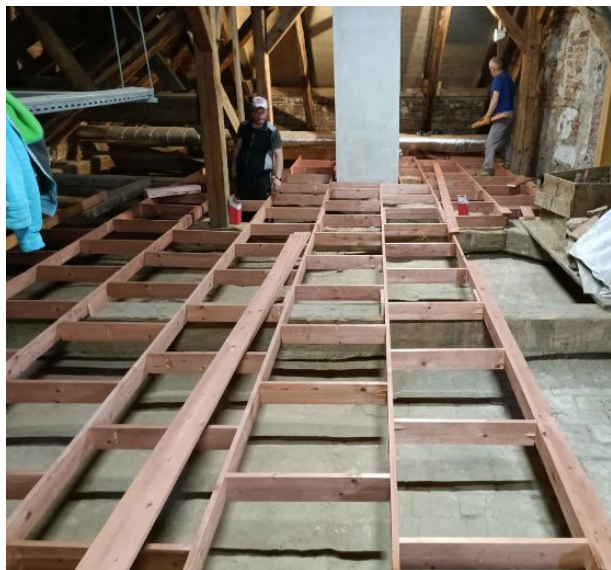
Rošt z nehoblovaných smrkových fošen tvořící základ podlážky.
